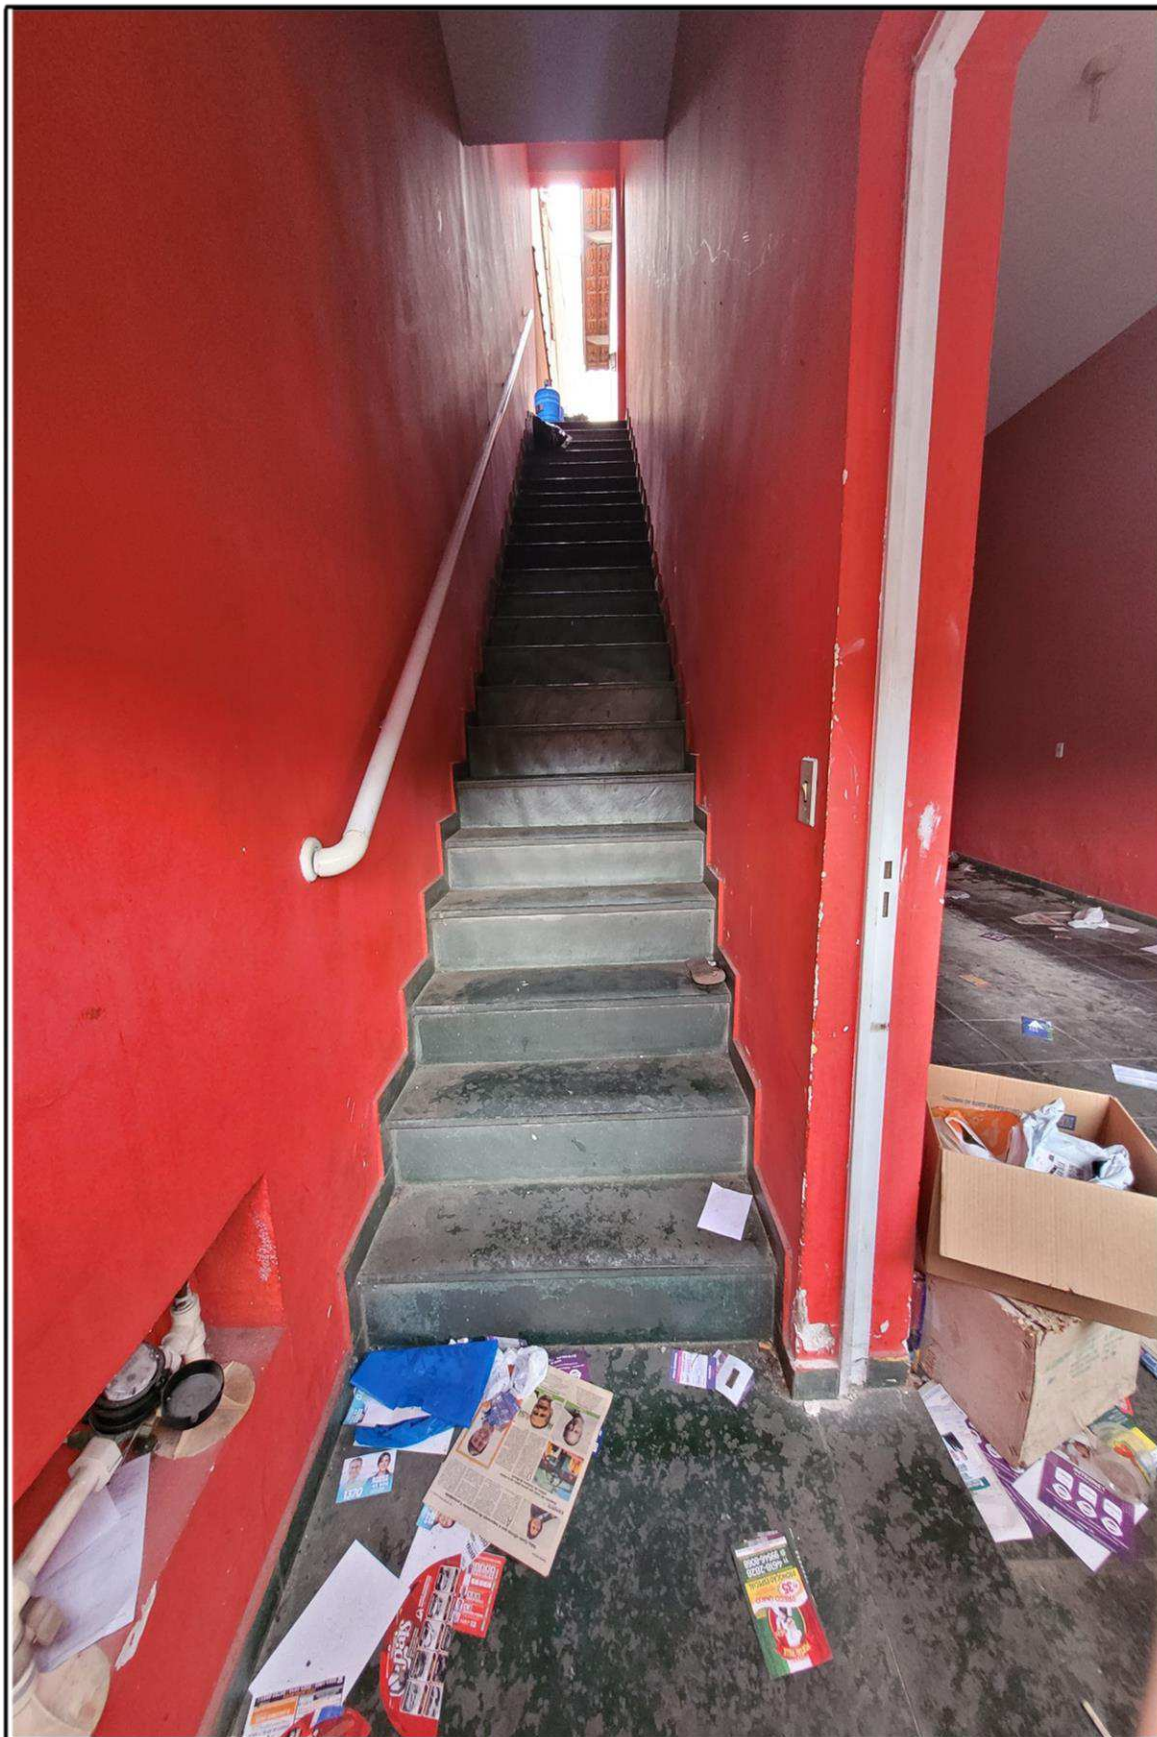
Vista da escada de acesso aos pavimentos superiores.
